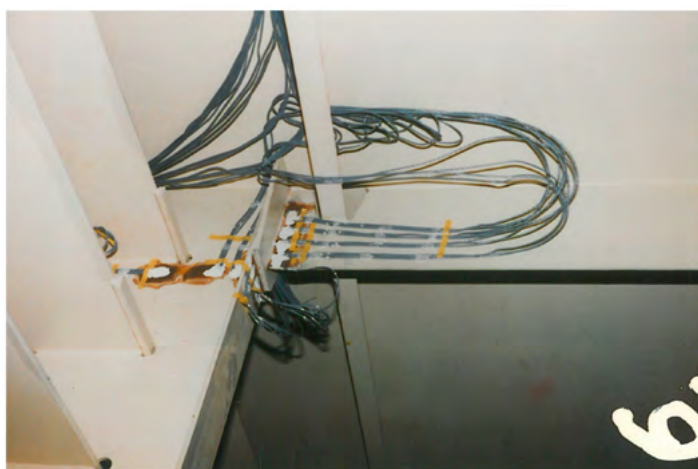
Instrumentation par jauges de déformation d'un assemblage soudé
